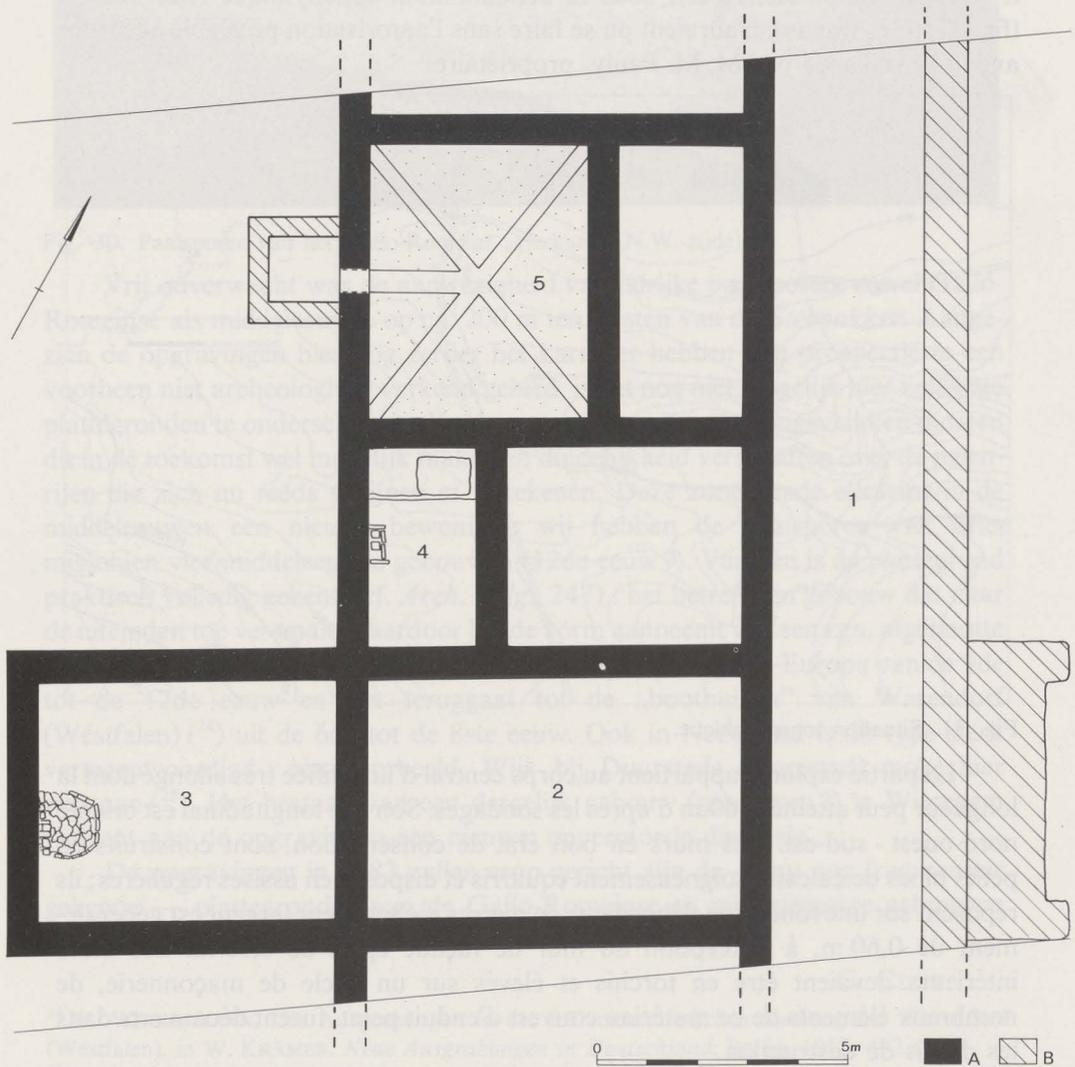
Plan de la tranchée. A : premier état, B : développement ultérieur.
